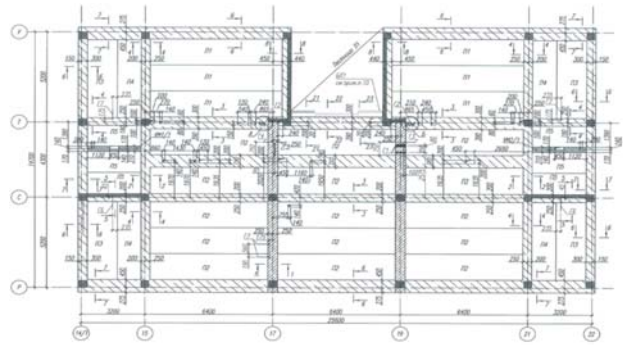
План типового поверху будівлі / Plan of a typical floor of a building
